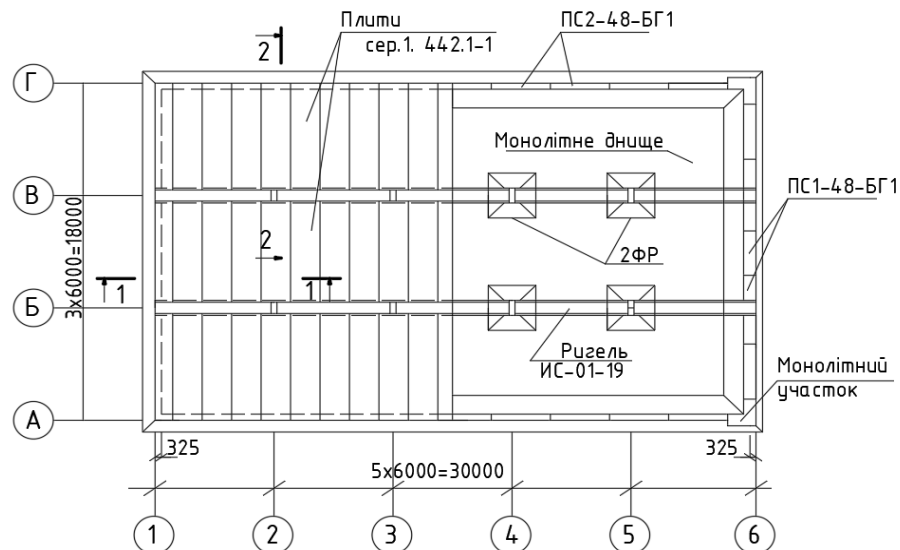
Схематичний план резервуару чистої води місткістю 2400 м^3 з маркуванням конструкцій каркаса
